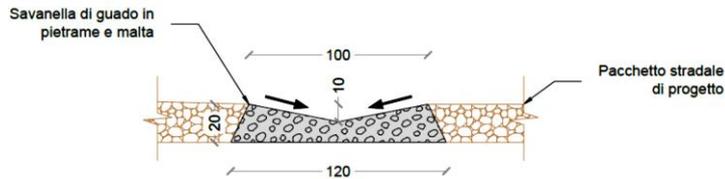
Sezione "Tipo" canaletta di drenaggio realizzata in scavo
